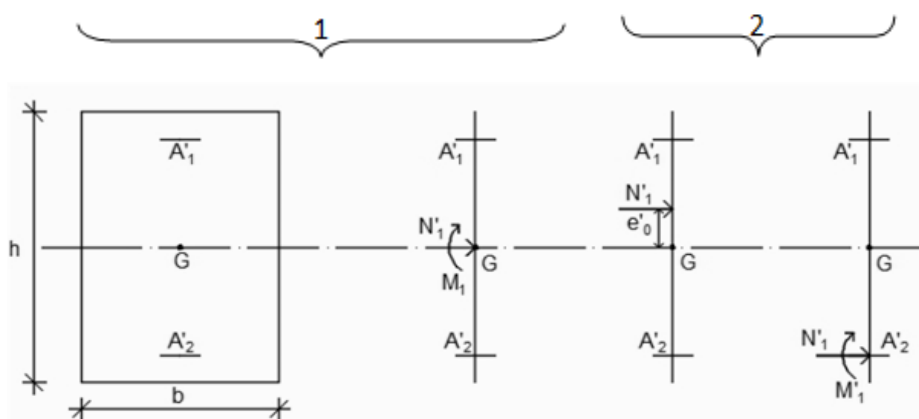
Position de N'_1 M'_1 et M_1 sur la section transversale.
